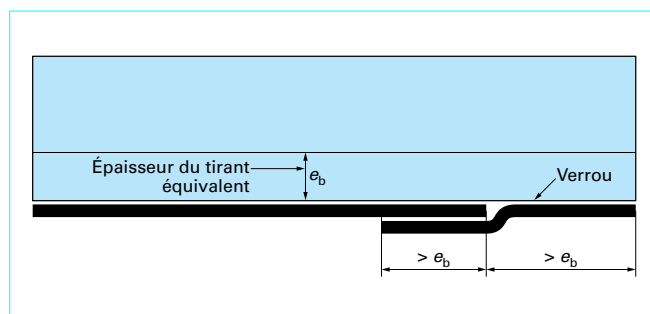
Exemple de verrou dans le cas de renforcement au moment fléchissant
